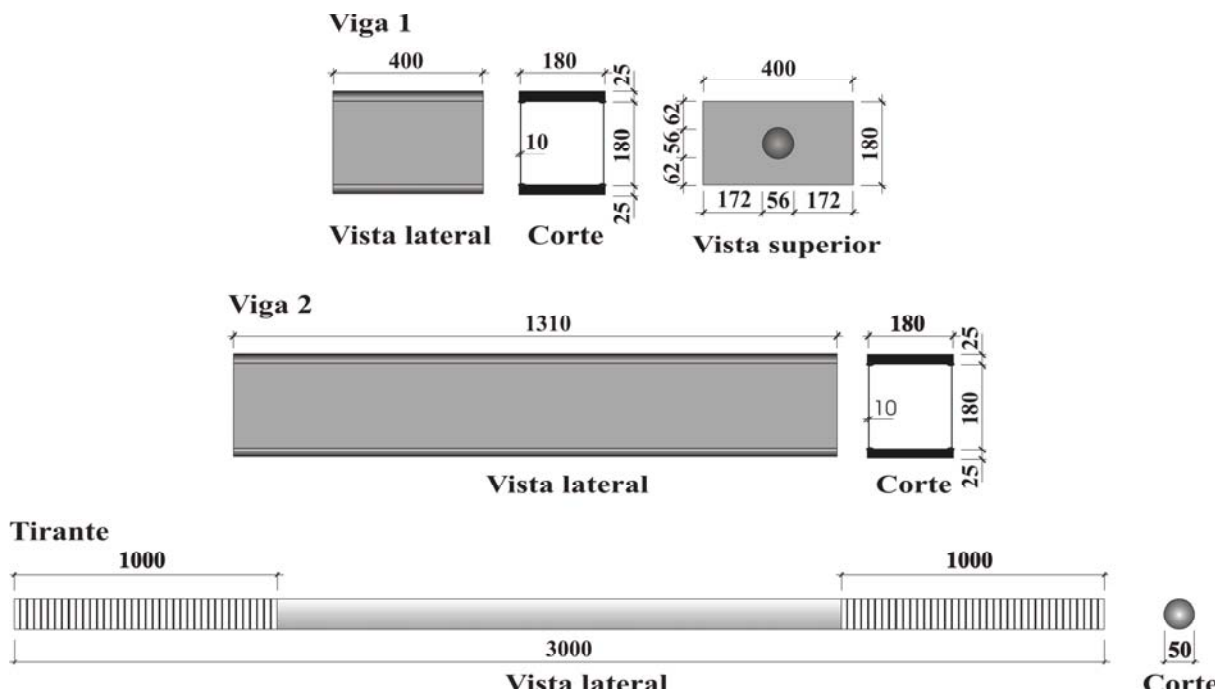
Vigas metálicas e tirante - sistema de reação - (mm)
